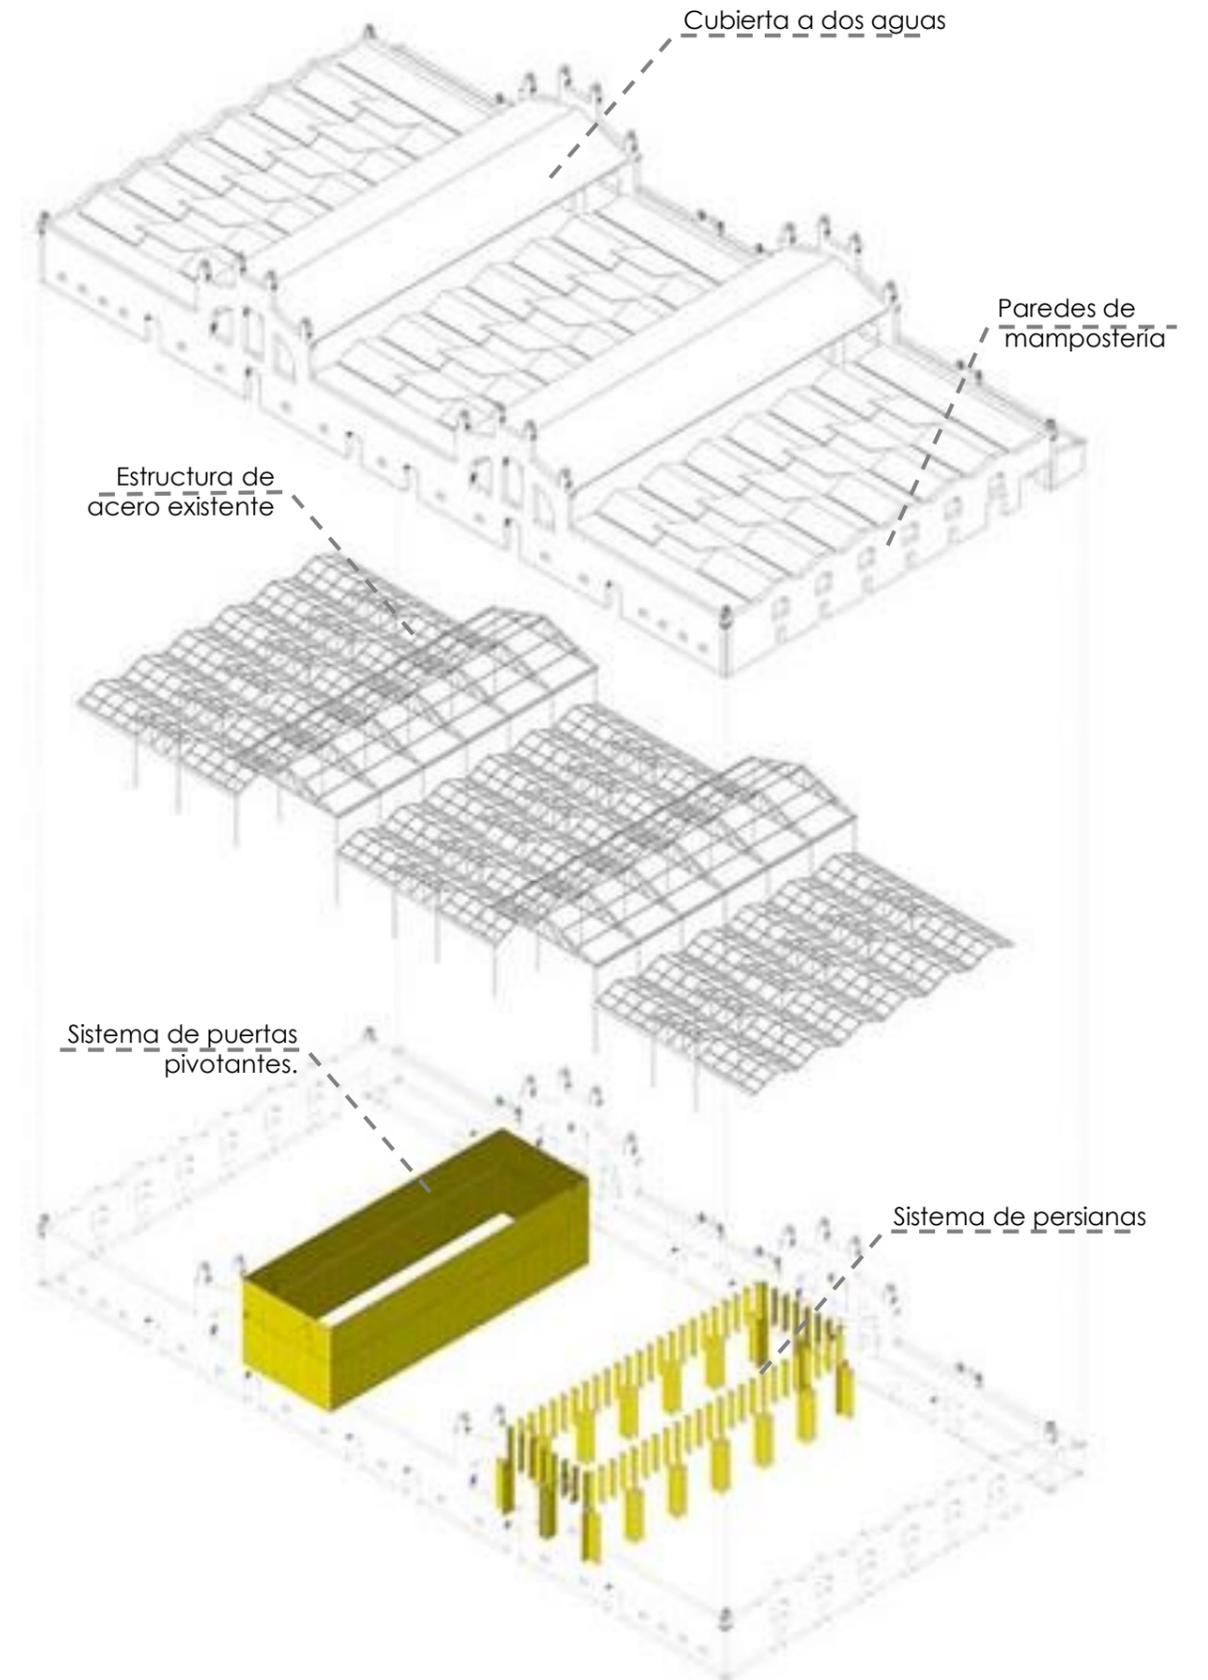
Esquema estructural de la Nave 16. Fuente: Virseda Vila Architects.
